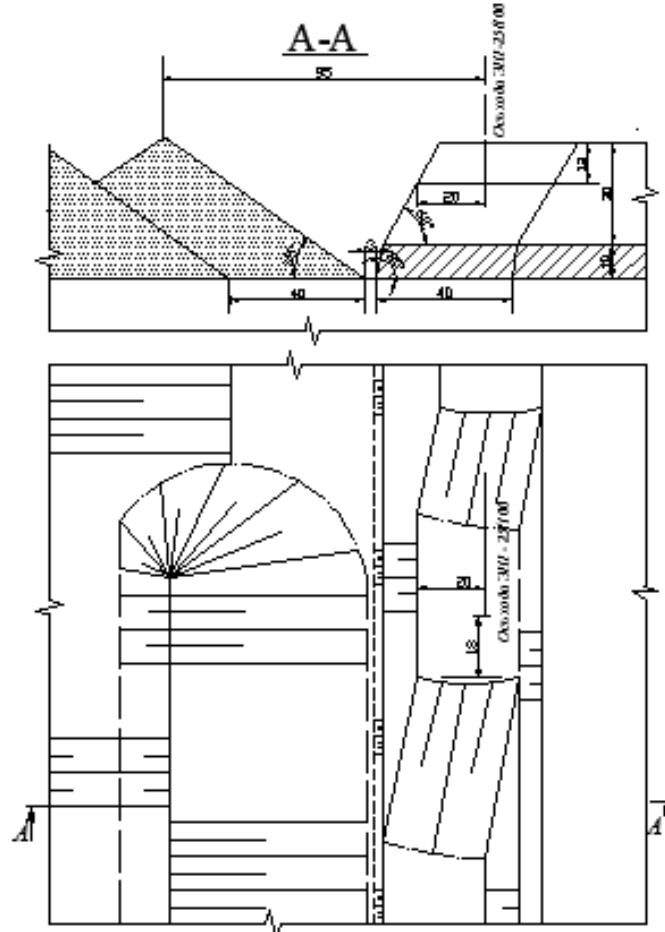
Схема с установкой ЭШ-25/100 на подуступе
